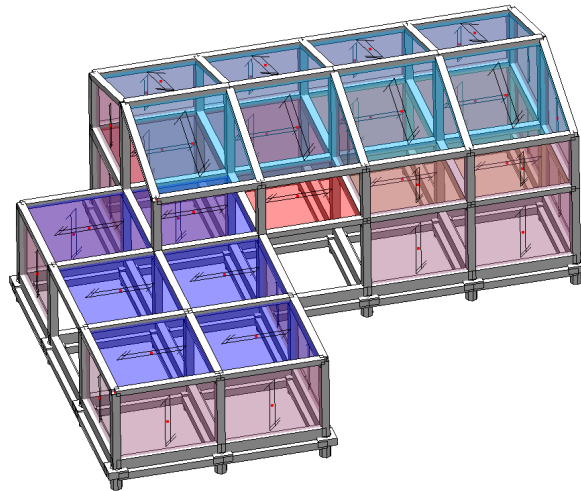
Schema modello 3D ad elementi finiti con vista solida
